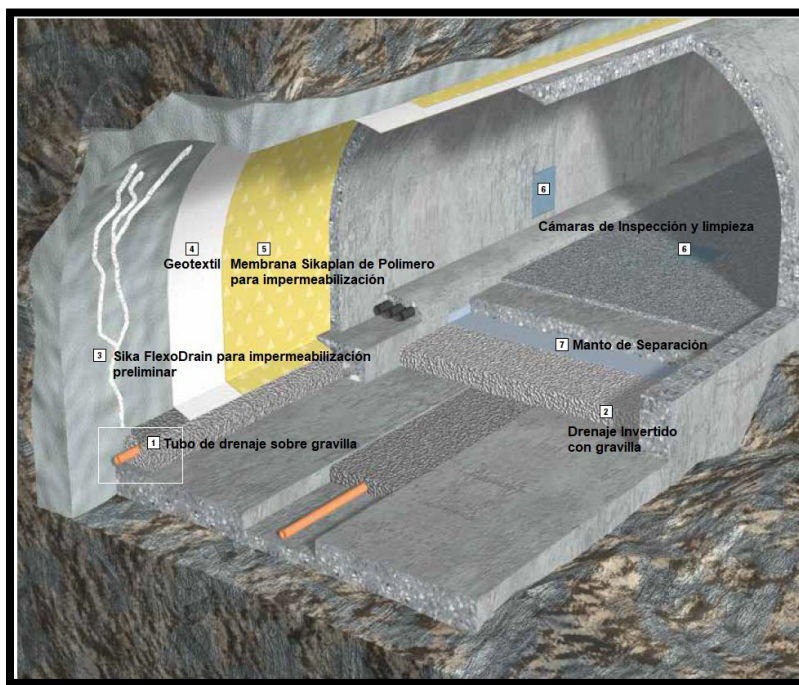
Sistema de Impermeabilización de un túnel excavado con P&T.
